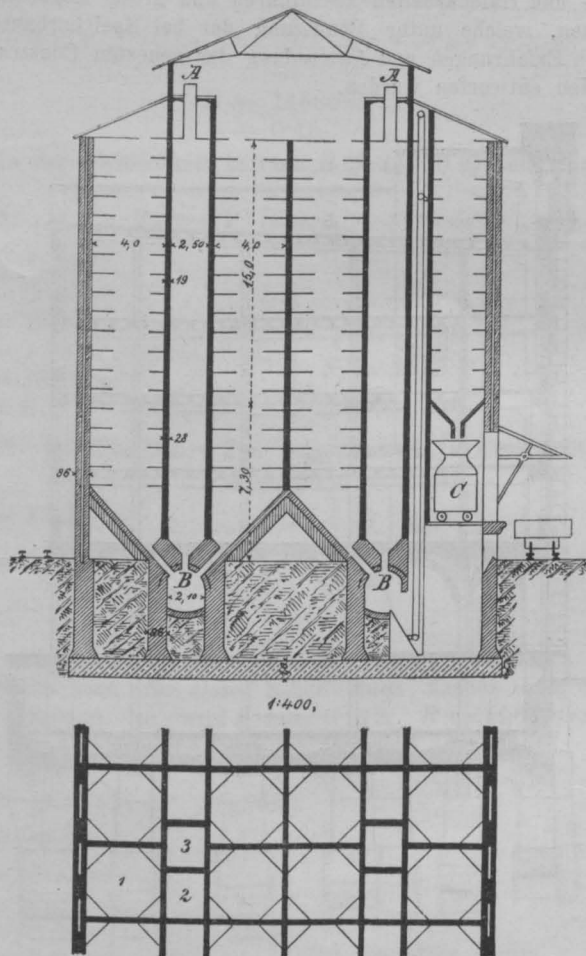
Schnitt und Grundriss des Silo-Speichers in Antwerpen.
